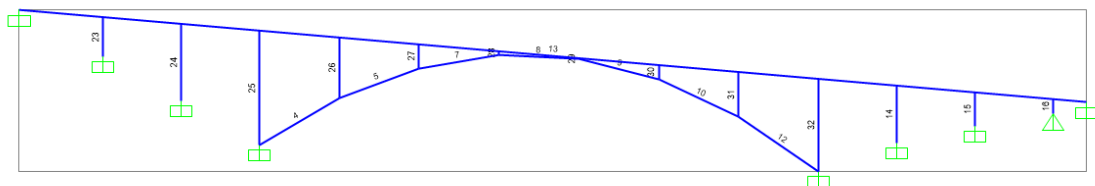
Modelo de cálculo del puente representado en SAP2000.
